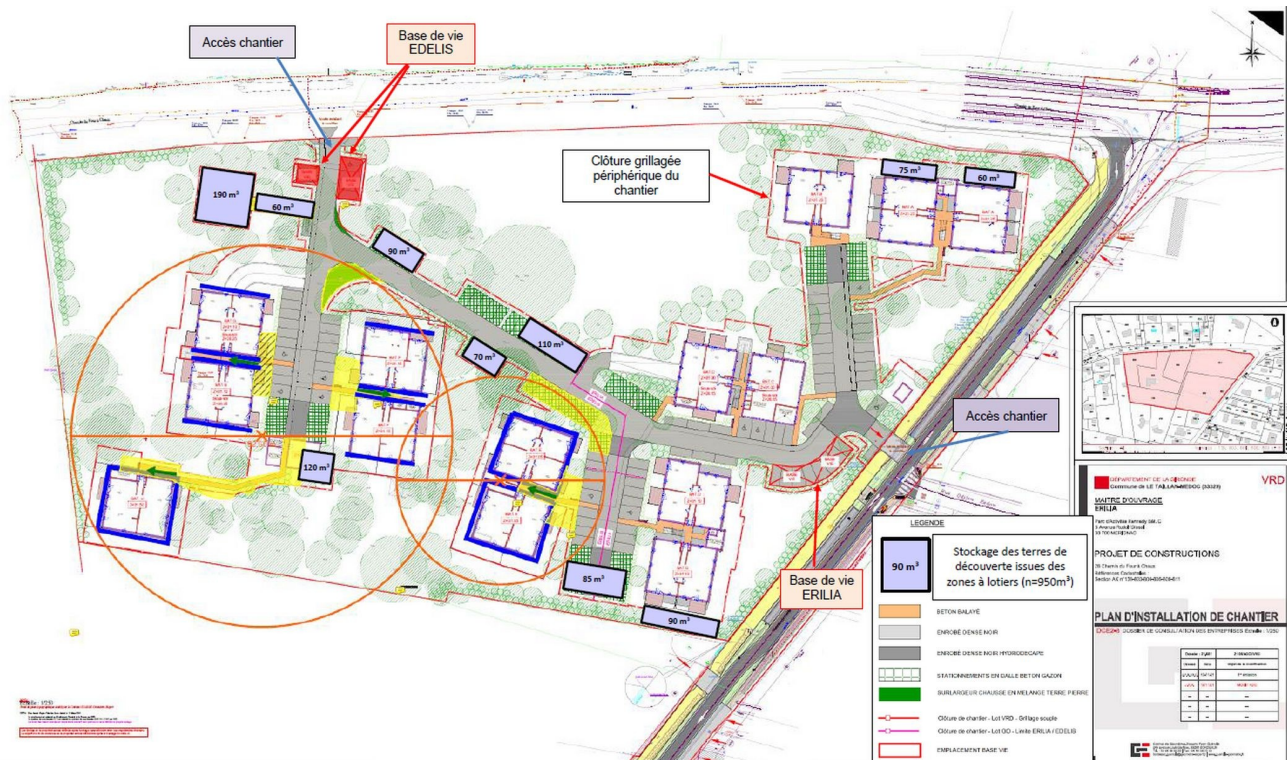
Plan d'installation du chantier (cf page 150 du dossier de demande de dérogation)
